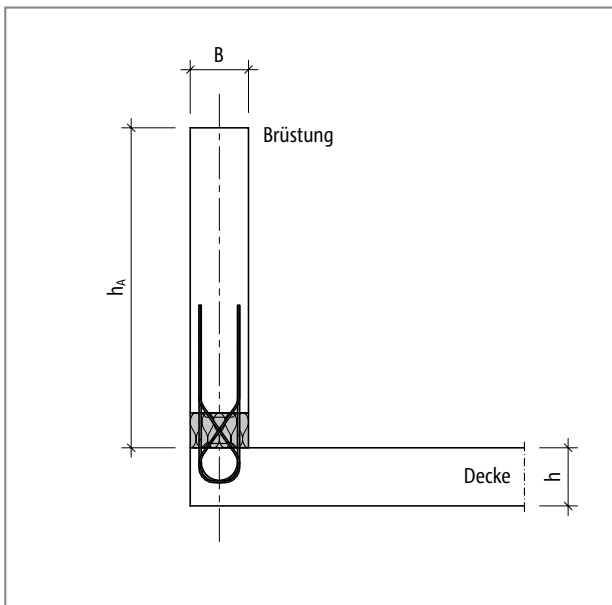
Schöck Isokorb® XT Typ AP: Statisches System Brüstungshöhe h_A
